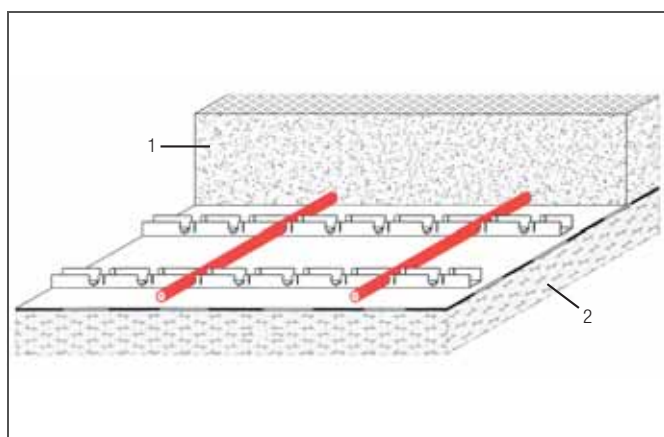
Бетонная плита, армированная стальной стружкой; специальная конструкция: отопительные трубы смонтированы на фиксирующих шинах
